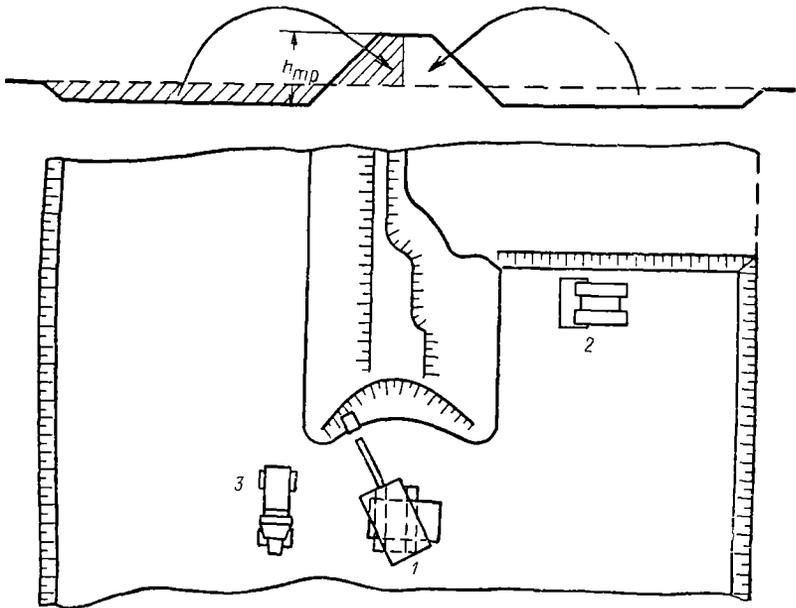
Схема совместной работы бульдозера с экскаватором на снятии растительного грунта, и погрузка его в транспортные средства:
